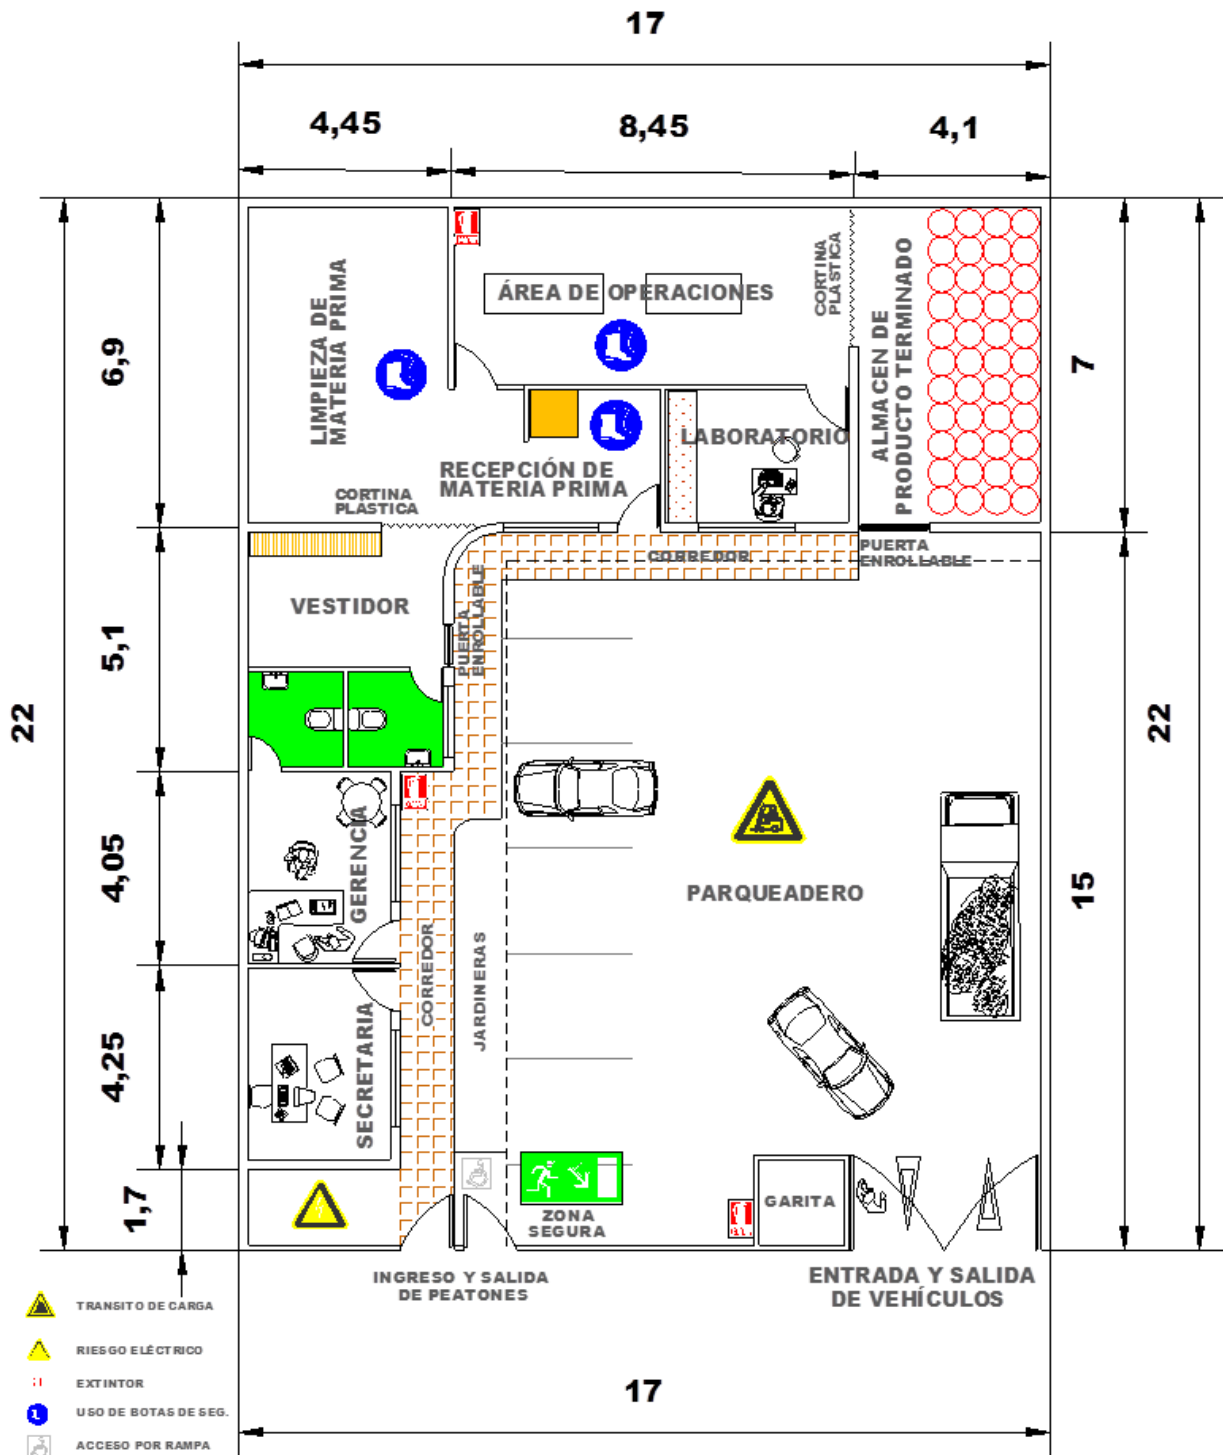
Distribución de las áreas de la planta de extracción de aceite crudo de girasol
